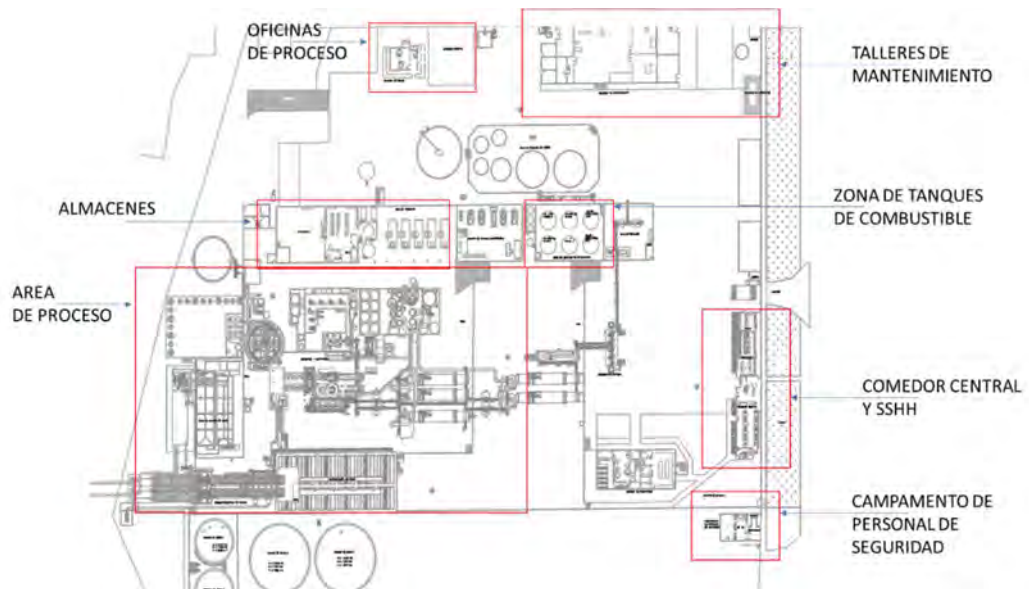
Plano general de una planta pesquera. Fuente: Propia.
